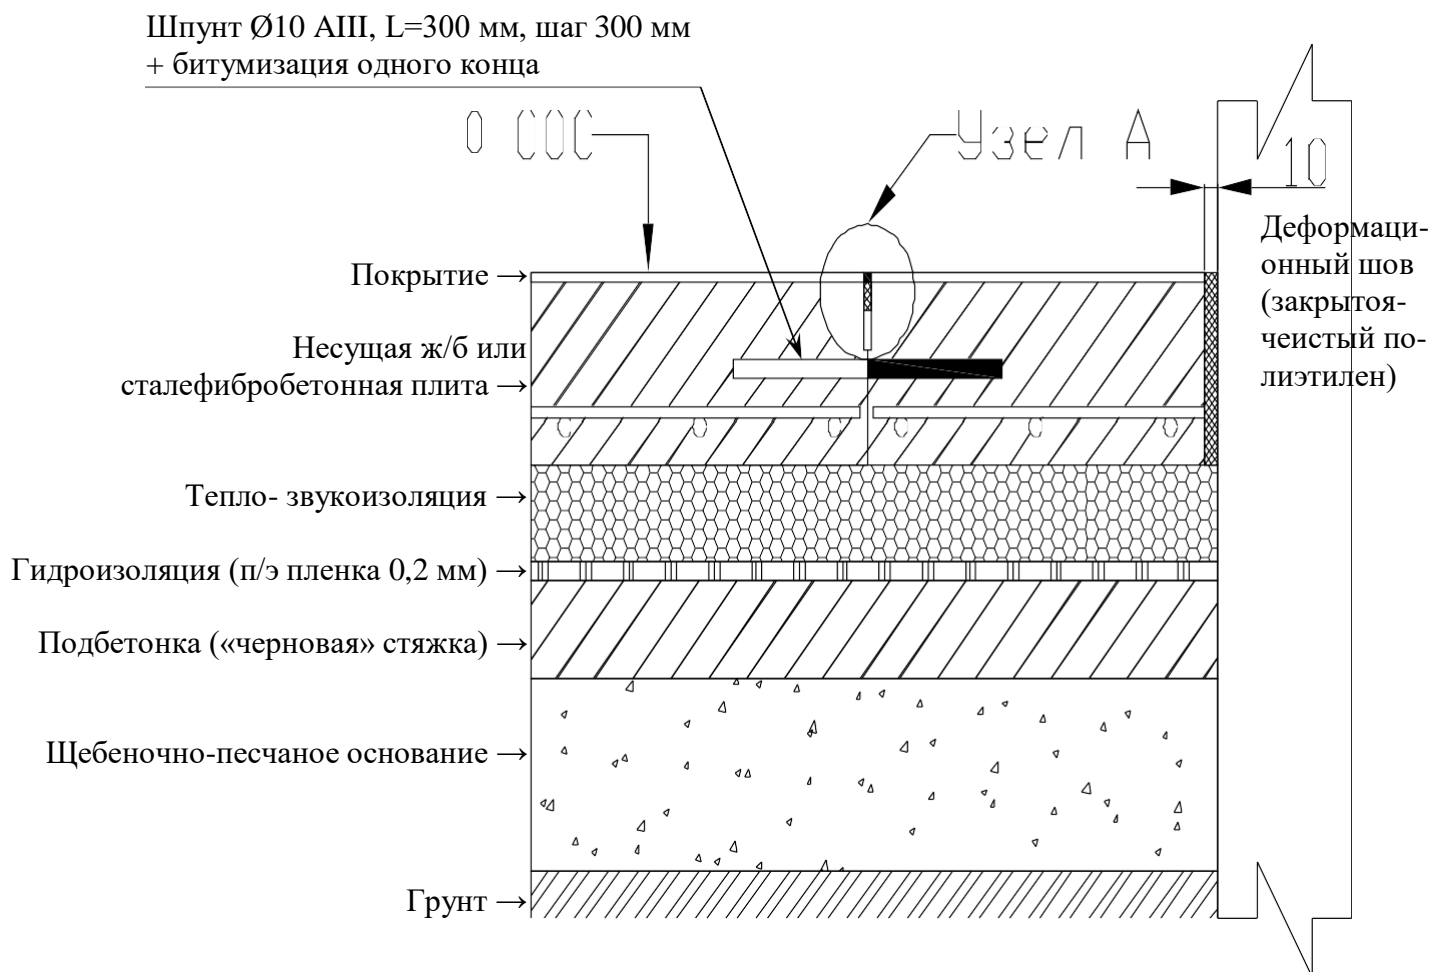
Конструкция бетонного пола укладываемого на грунт.
